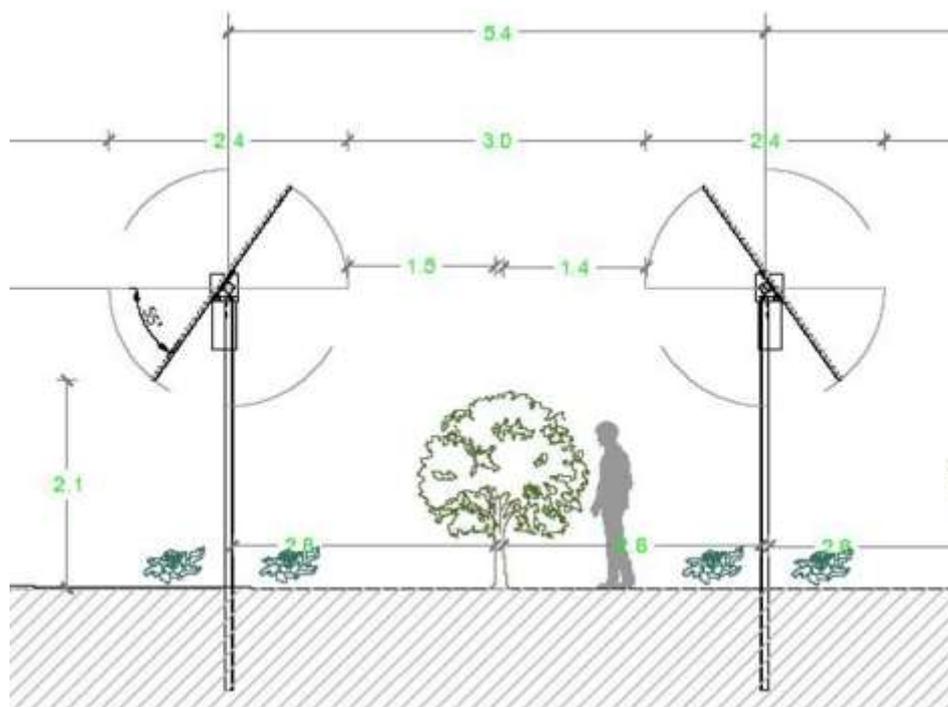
Particolare sezione struttura tracker inclinata a 55° - impianto standard
